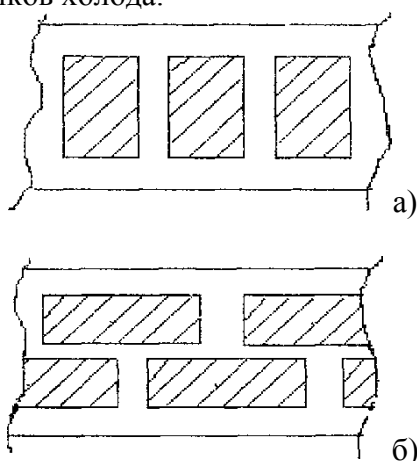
Стена из монолитного железобетона с брусками из минеральных плит или пеносиликата
